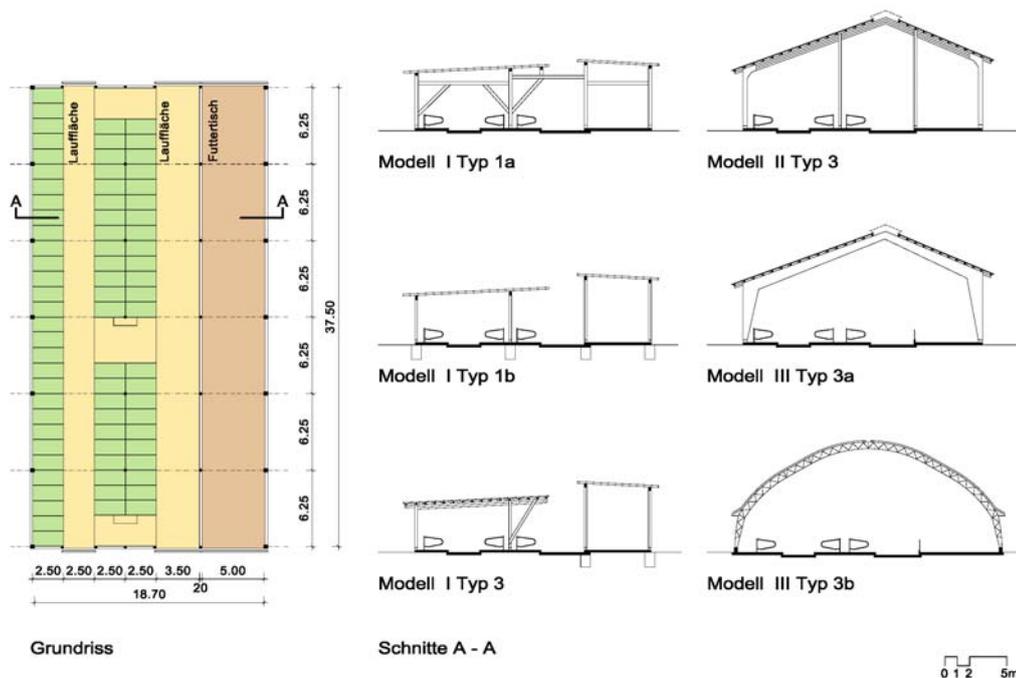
Grundriss und Schnitte der Stallmodelle I – III
